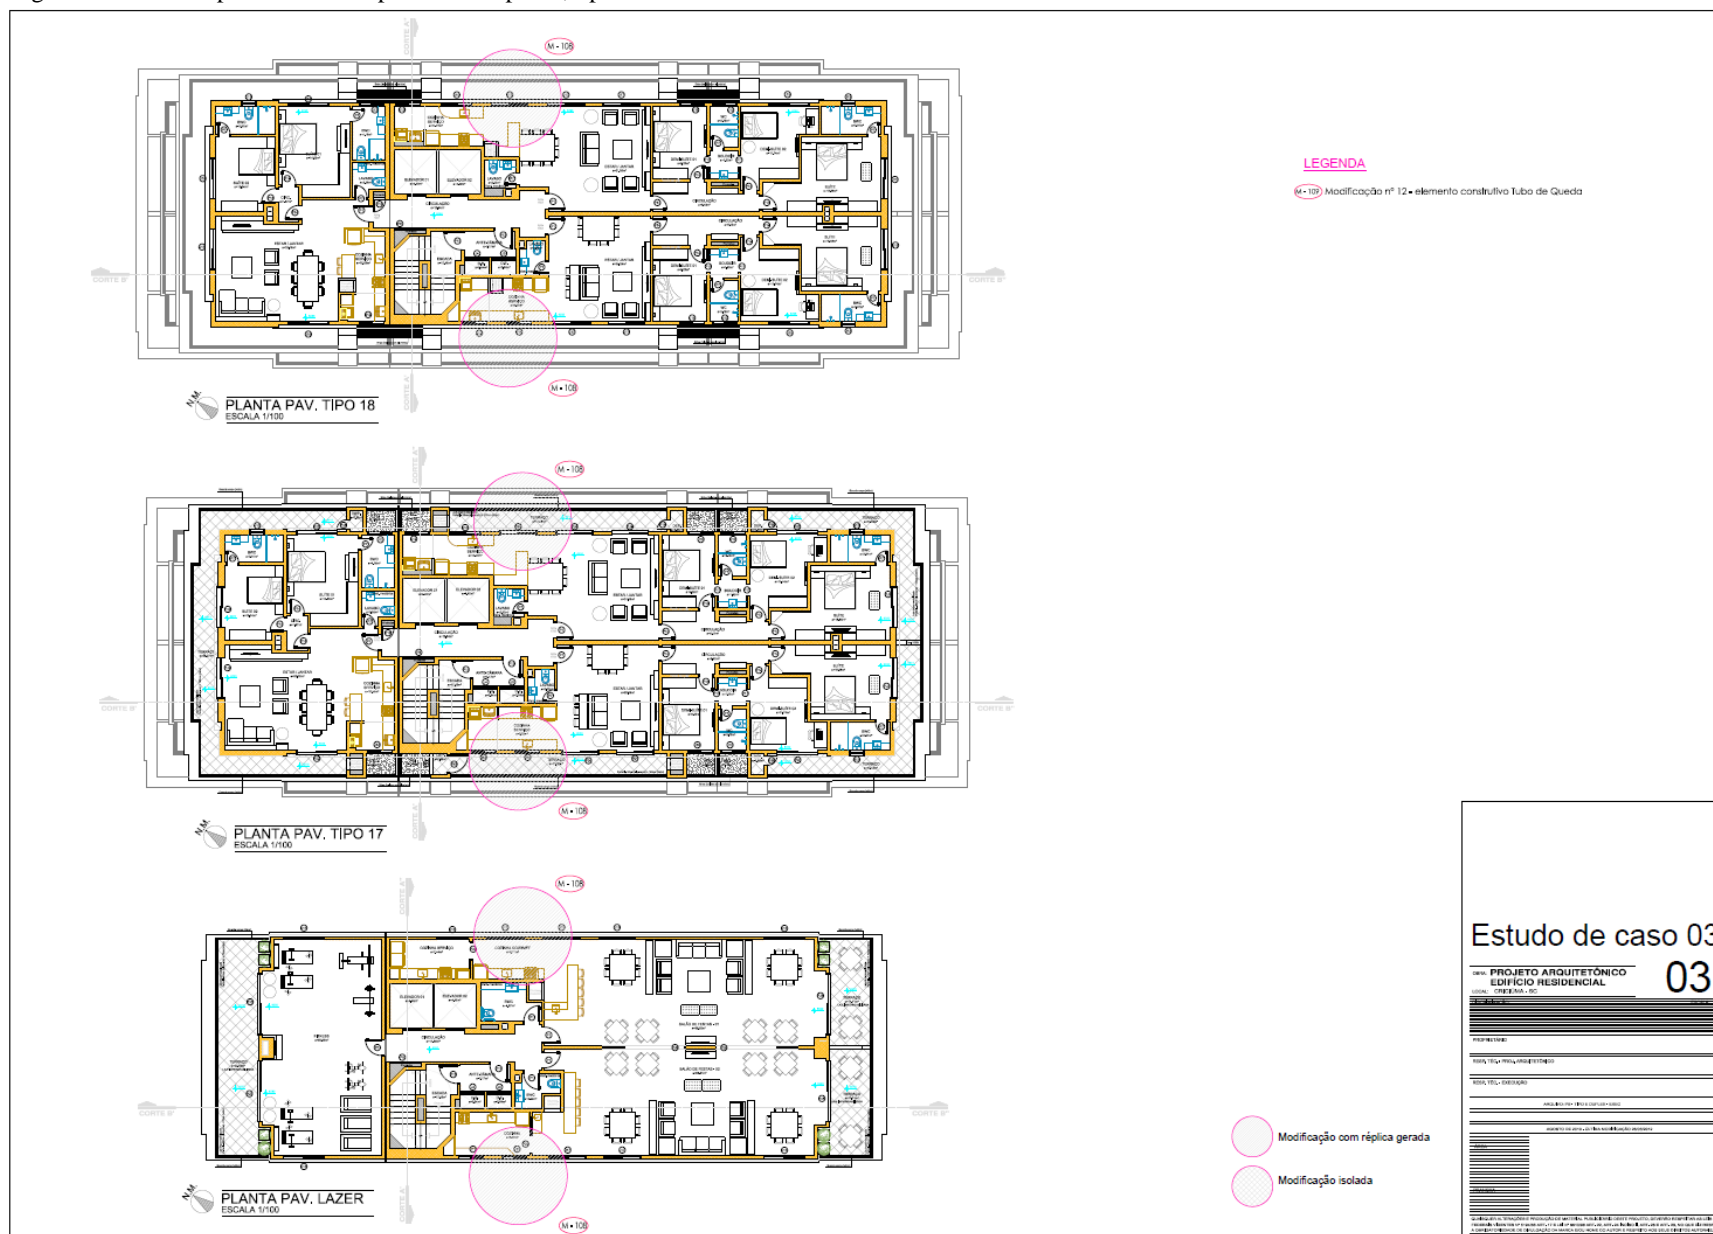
E.C. 03 planta baixa do pavimento tipo 17, tipo 18 e lazer.
